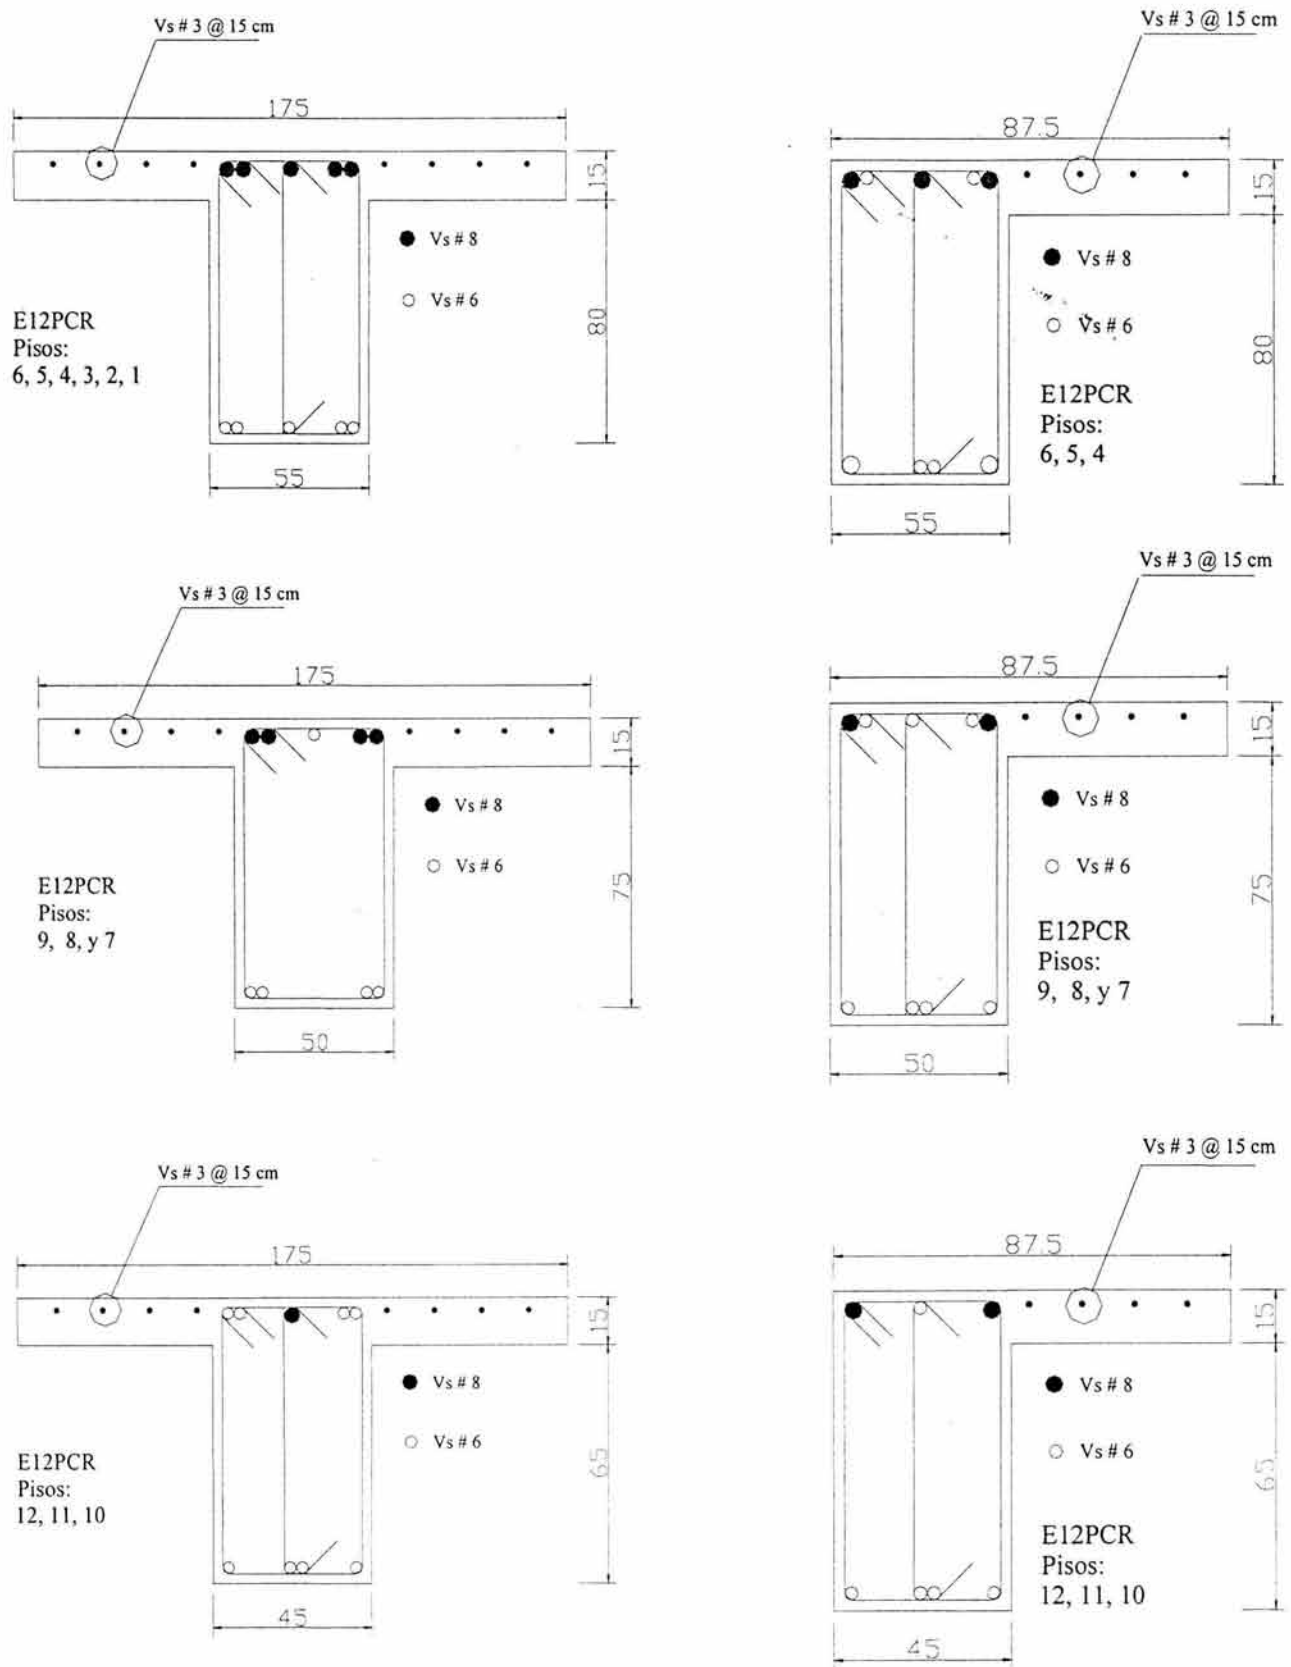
Detallado de vigas en edificio de 12 niveles.
